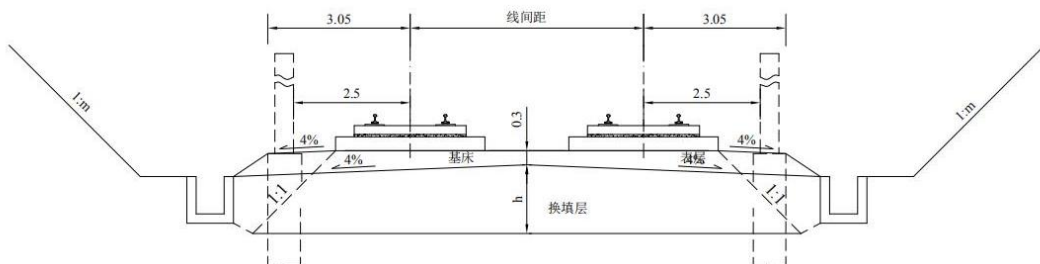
无砟轨道双线非硬质岩路堑横断面图二 (单位: m)
